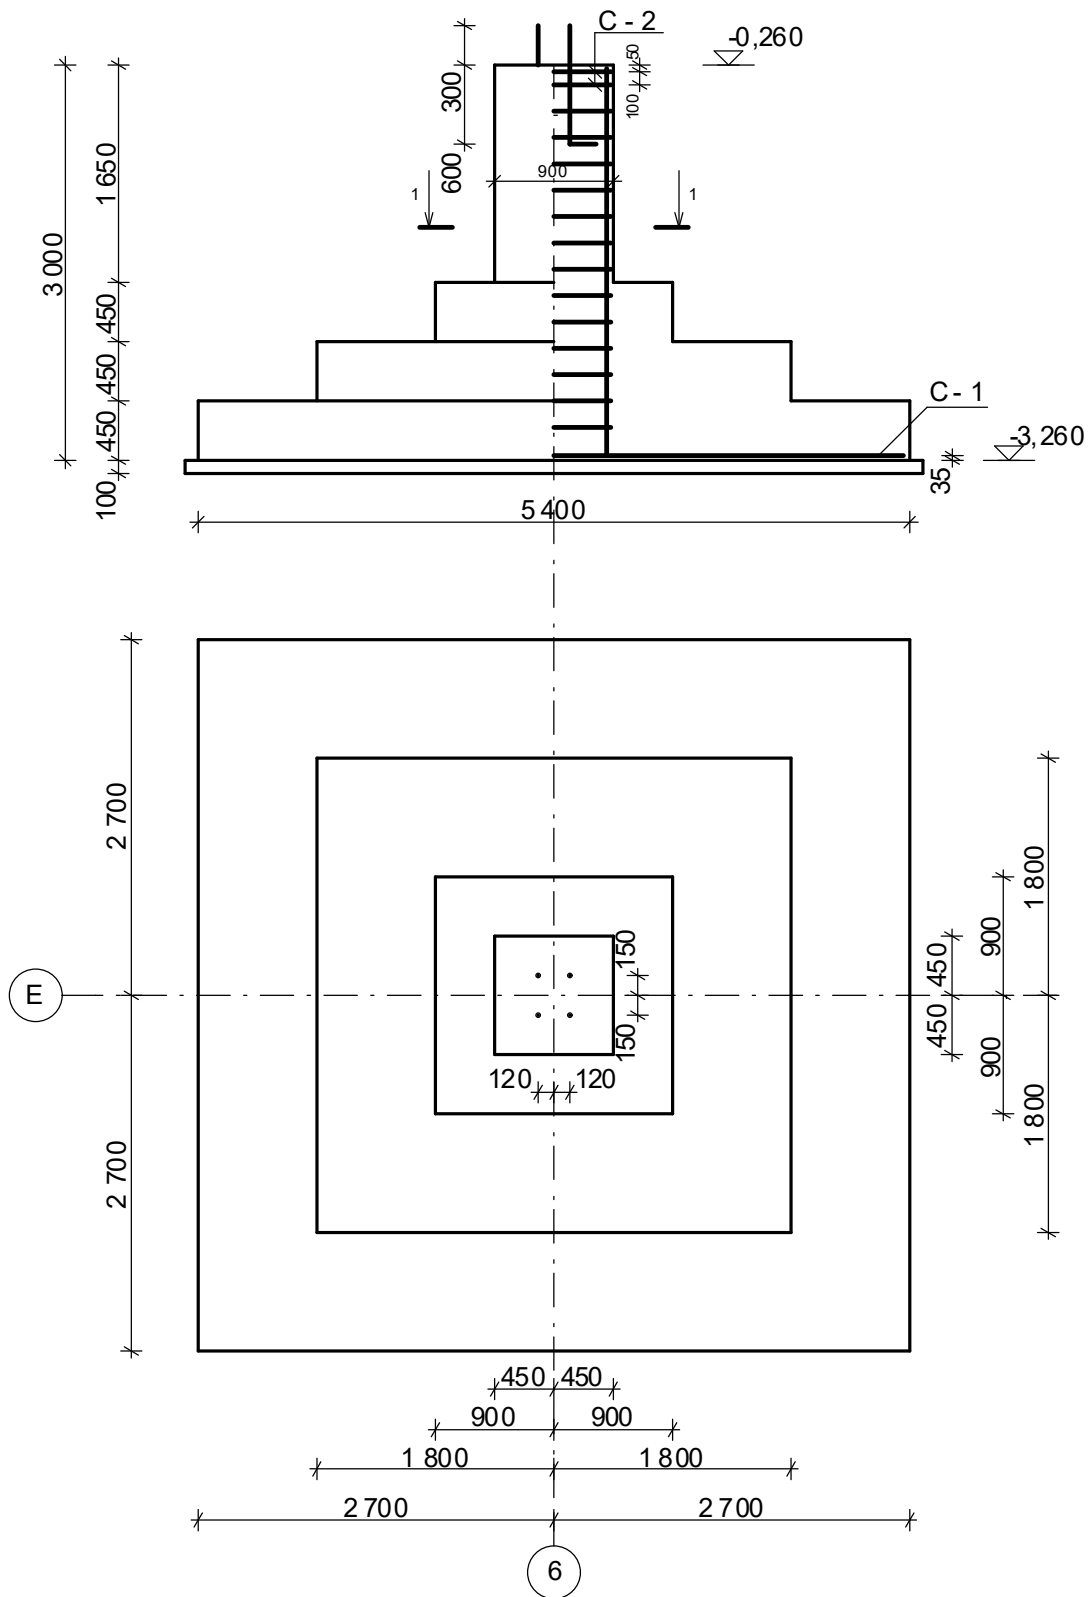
Конструктивне рішення фундаменту мілкового закладання під металеву колону
